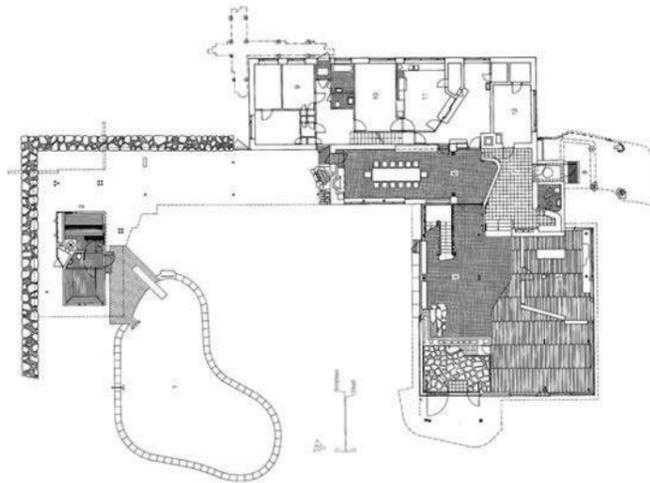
Grundriss Villa Mairea, Alvar Aalto
